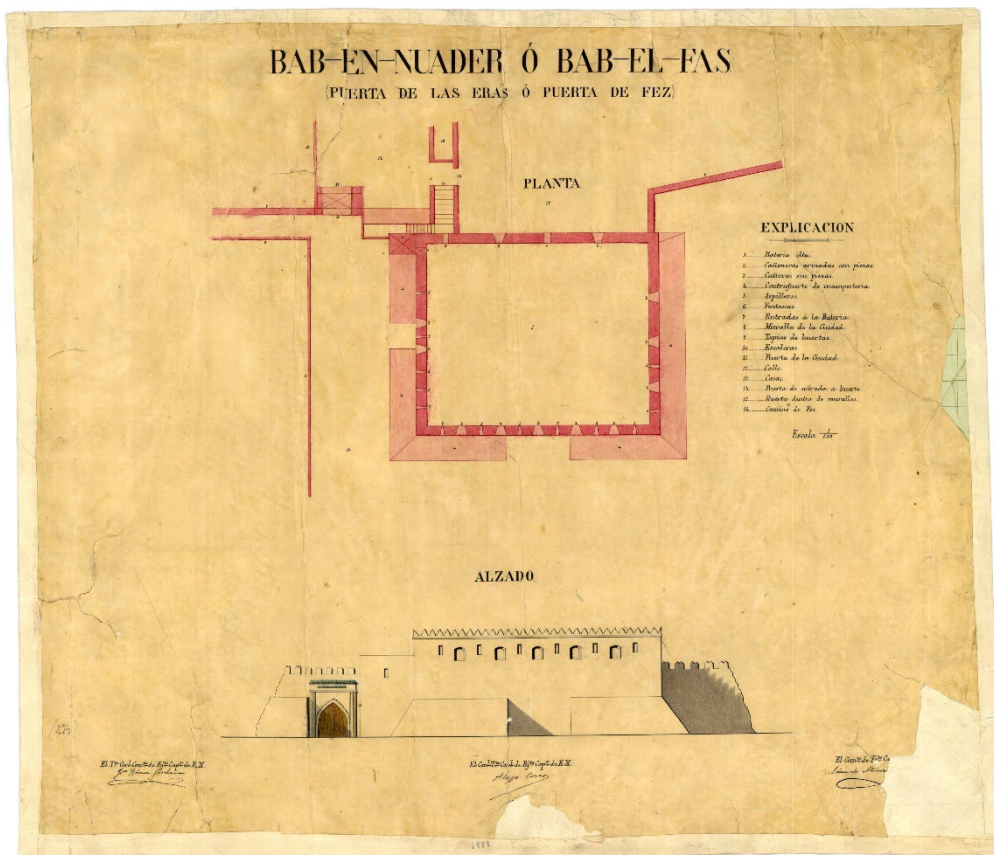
Planta y Alzado de Bab Nuader, 1888 (Archivo del Servicio Geográfico del Ejército, Madrid) (2).
